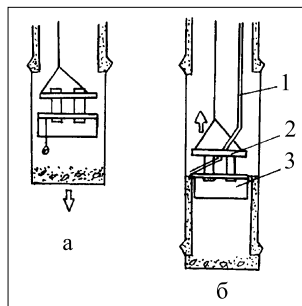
Послідовна схема проходки ствола: а – проходка ланки; б – кріплення ланки; 1 – бетонопровід; 2 – прохідницький поміст; 3 – пересувна опалубка.
